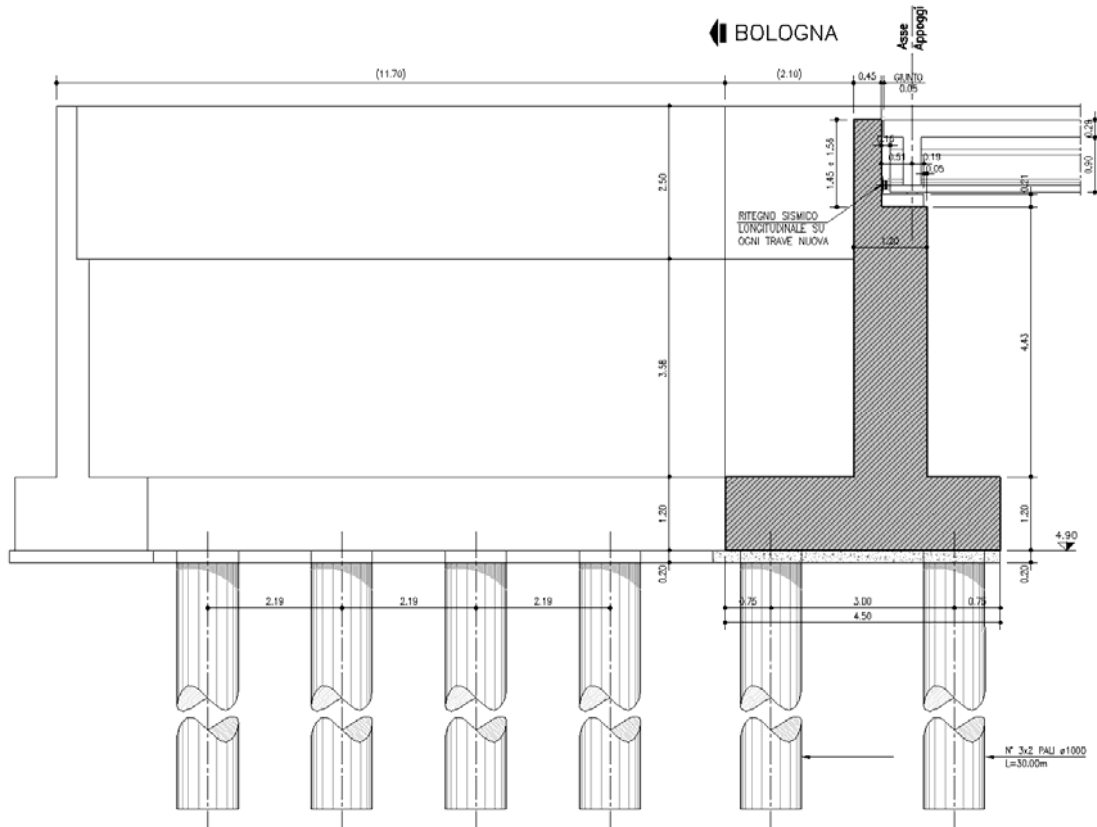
Sezione longitudinale spalla in ampliamento
